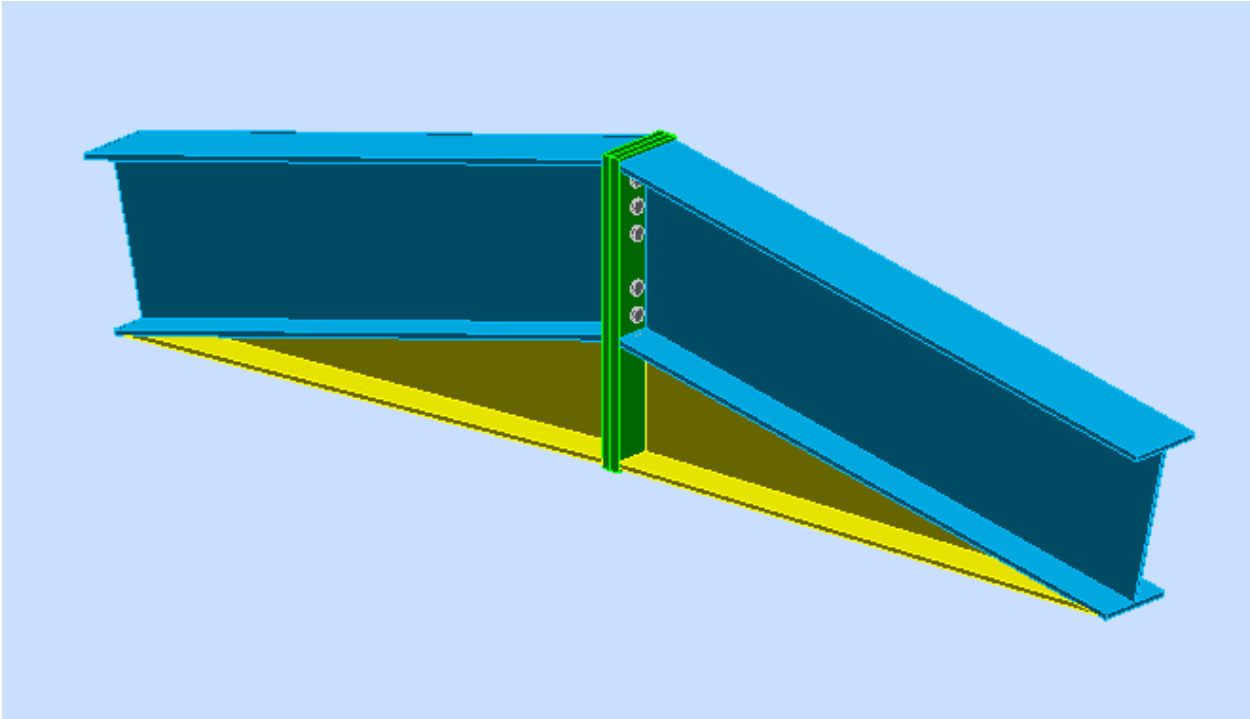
assemblage poutre IPE 360-poutre IPE 360 en 3D
